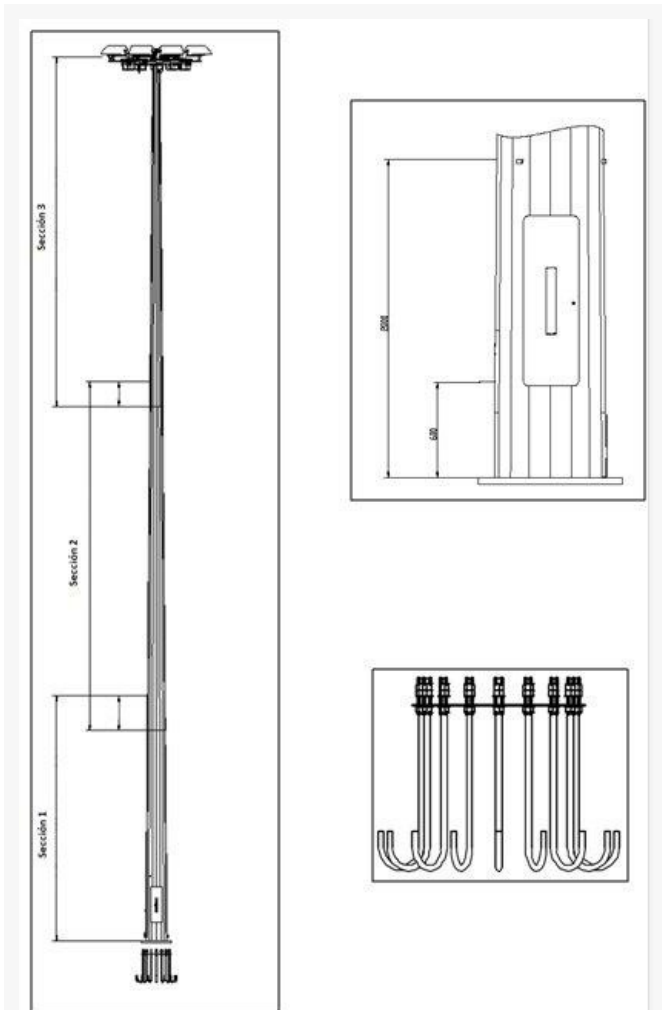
Vista perfil de poste, sistema de anclaje y puerta de acceso
